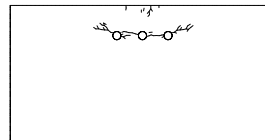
解析によるひび割れ状況(かぶり厚 $t_p=20\text{mm}$)
